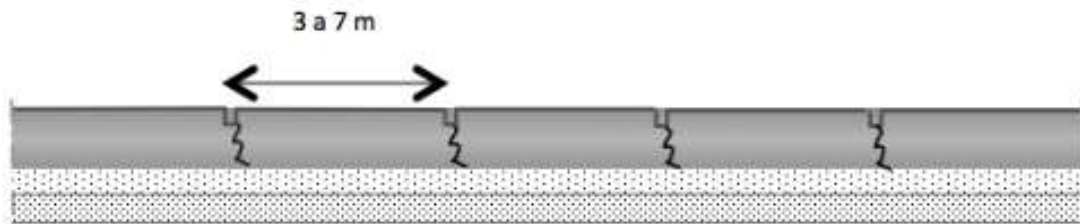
Pavimento de betão não armado com juntas (elaboração própria – adaptado de Picado Santos et al, 2011)
